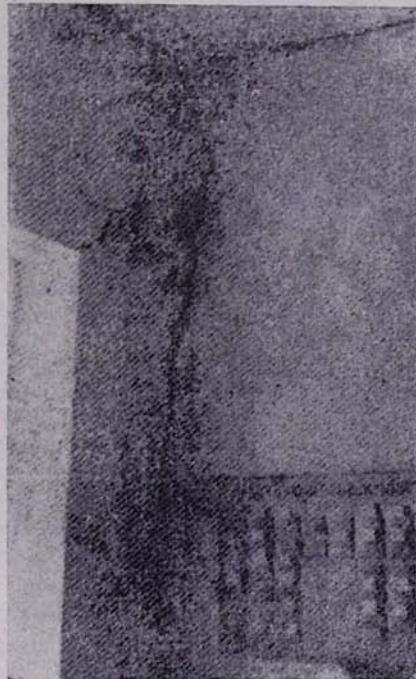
Характерные повреждения современного кирпичного здания: отрыв наружной продольной стены от поперечной, смещение настилов перекрытий, трещина в углу проема
